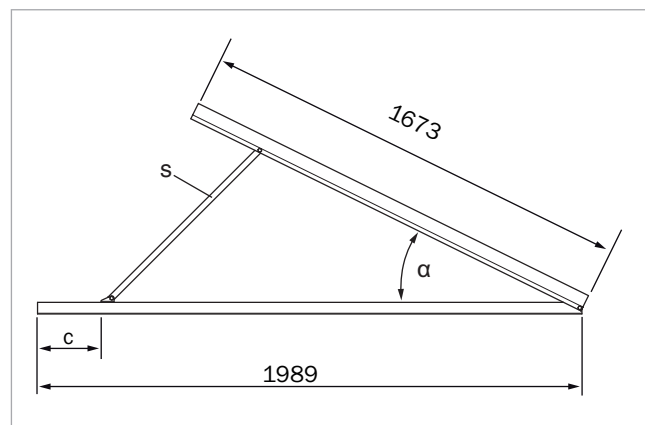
montants pour toit plat, dimensions et angle d'installation
